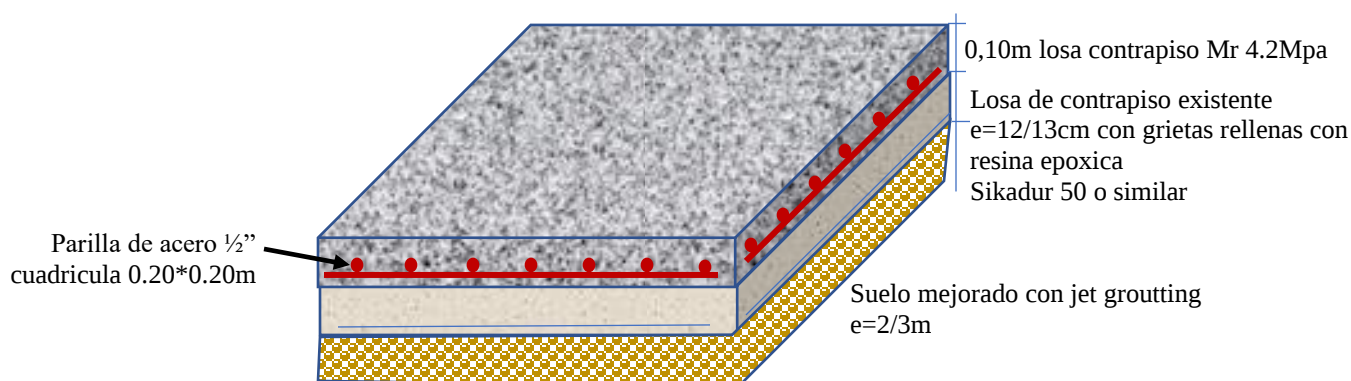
Detalle losa de contrapiso nueva en cuadrícula de 3.5*3.5m para hacer juntas de dilatación, apoyada sobre losa existente y suelo mejorado con jet grouting
